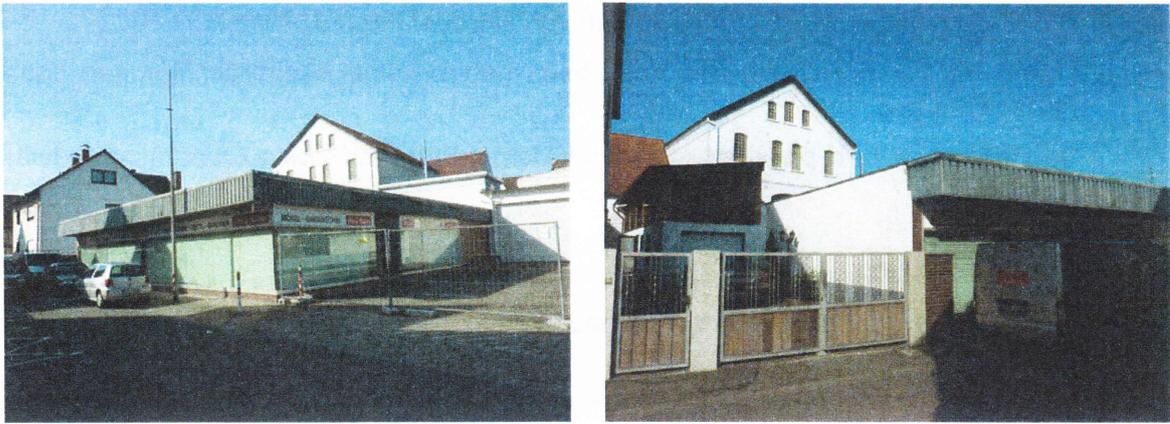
und 5: Bestehende Bebauung im Plangebiet
